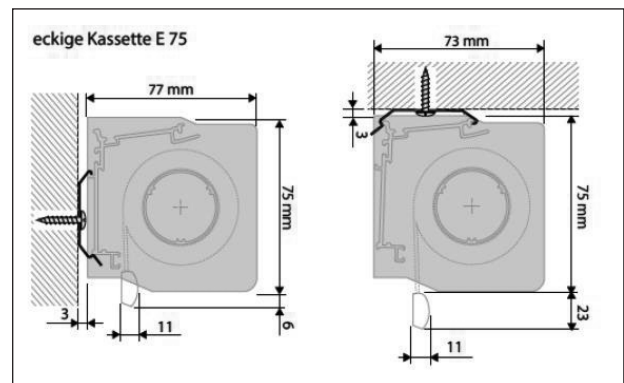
Wand- und Deckenmontage mit eckiger Kasette, Einbau mit Halteclip (Ansicht und Abmessungen beispielhaft)
